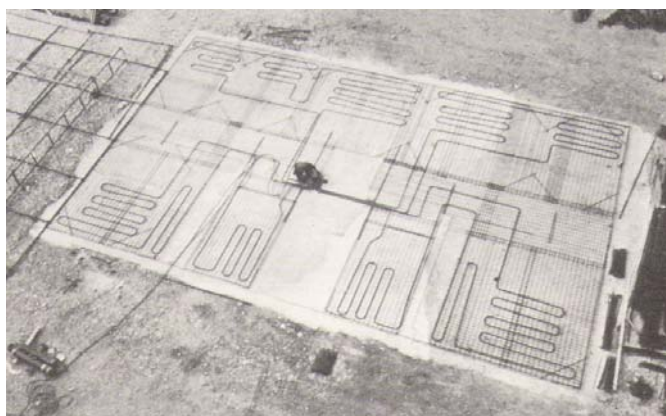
Serpentinhas utilizadas para calefação dos painéis (REVEL,1973).
